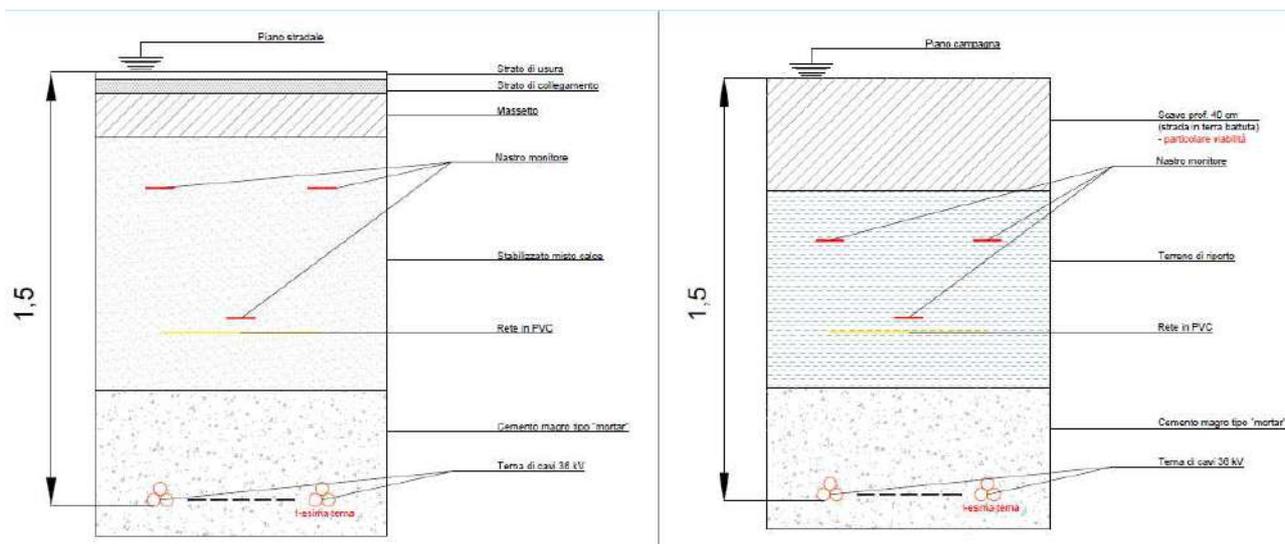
Sezione posa cavidotto interrato su piano di campagna e su strada asfaltata con misure espresse in metri.
